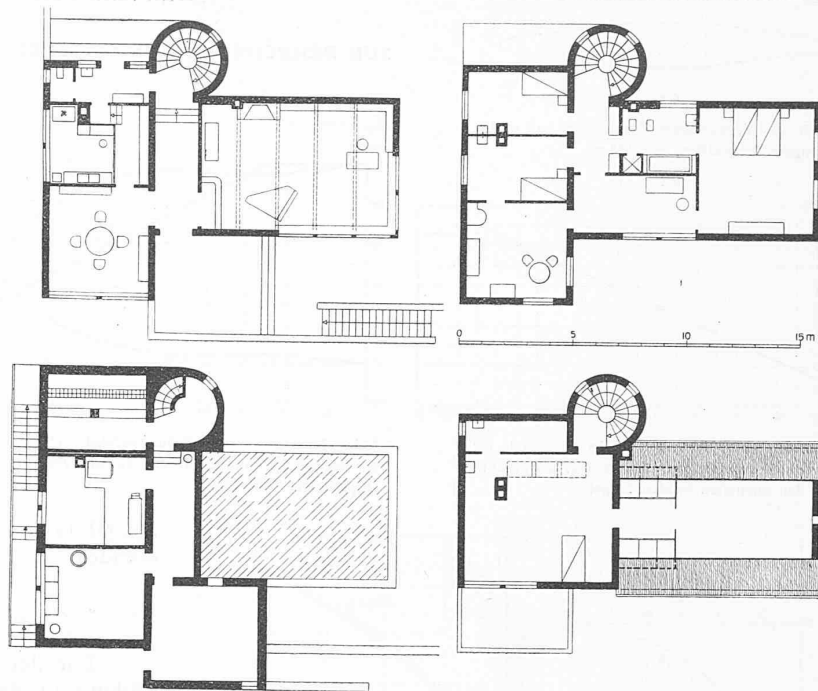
Haus B. Séquin in Zürich. — Grundrisse 1 : 300.
